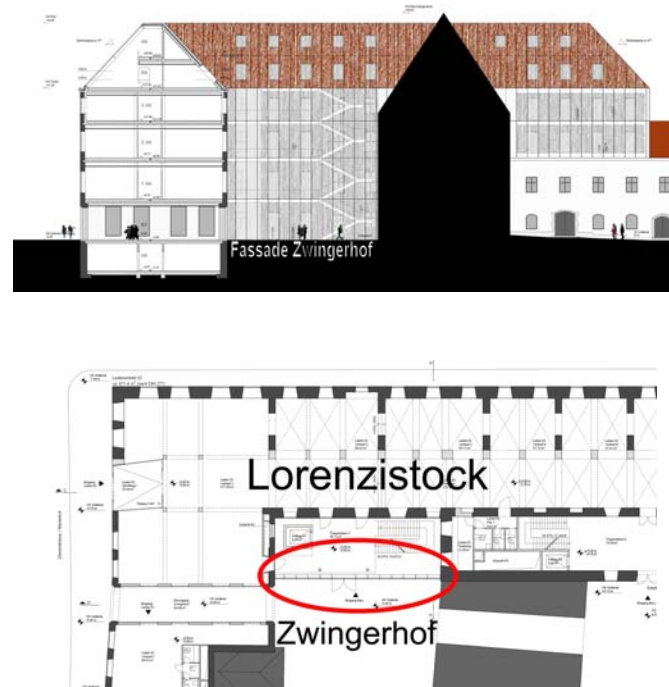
Ansicht und Grundriss der geplanten Pfosten-Riegelfassade hin zum Zwingerhof
